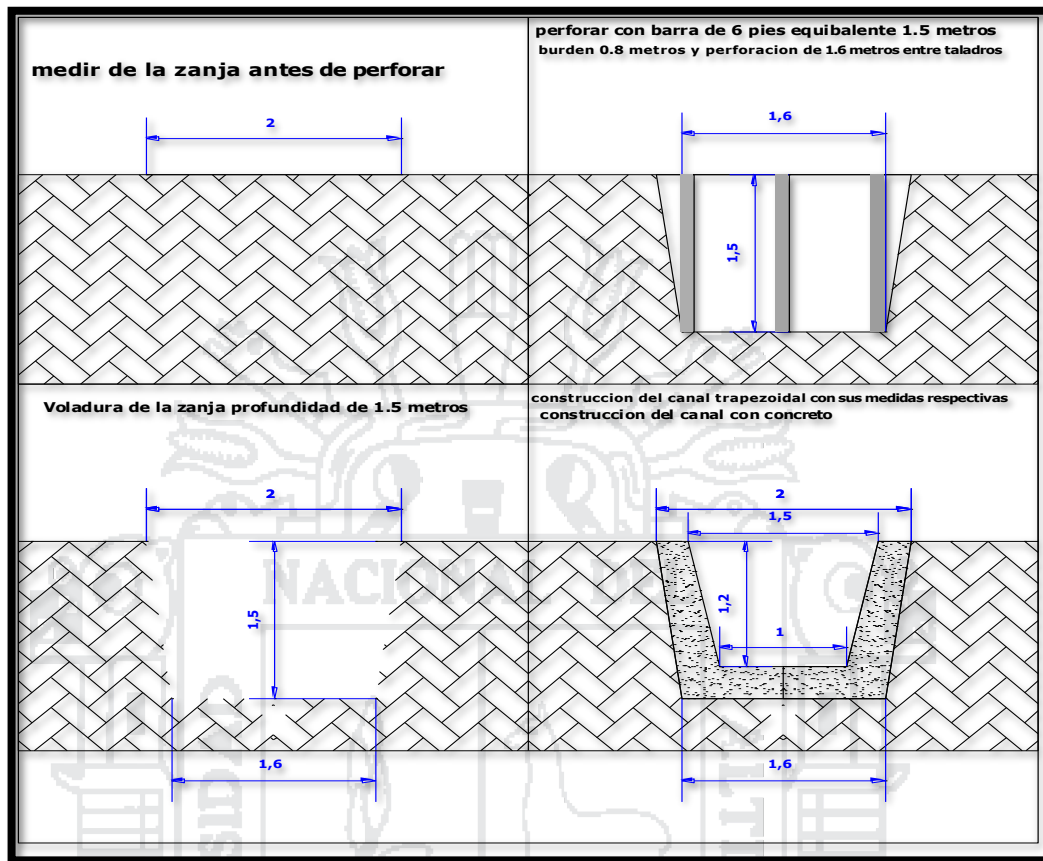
Diseño para perforación de zanja y construcción del canal.
